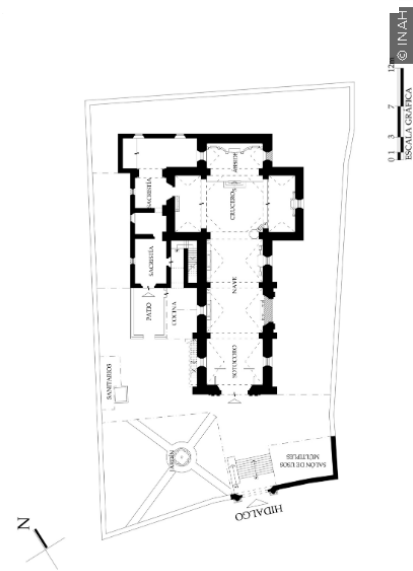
PLANTA ARQUITECTÓNICA (INAH 2014)
